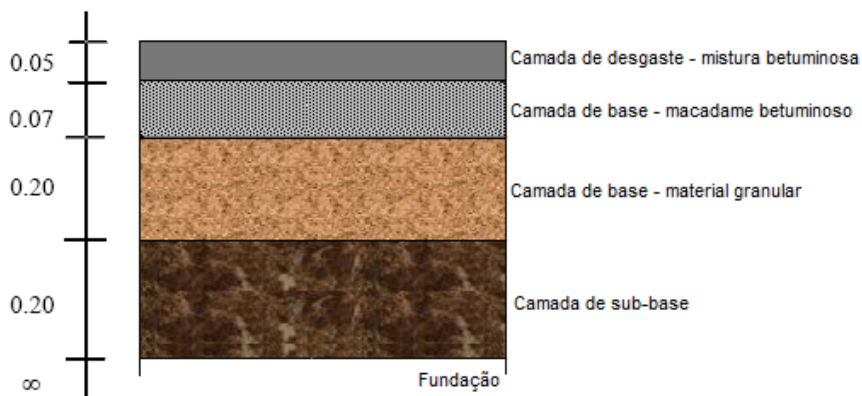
Estrutura do pavimento degradado – Caso 2 (Adaptado de Picado-Santos & Pereira, 2006)
